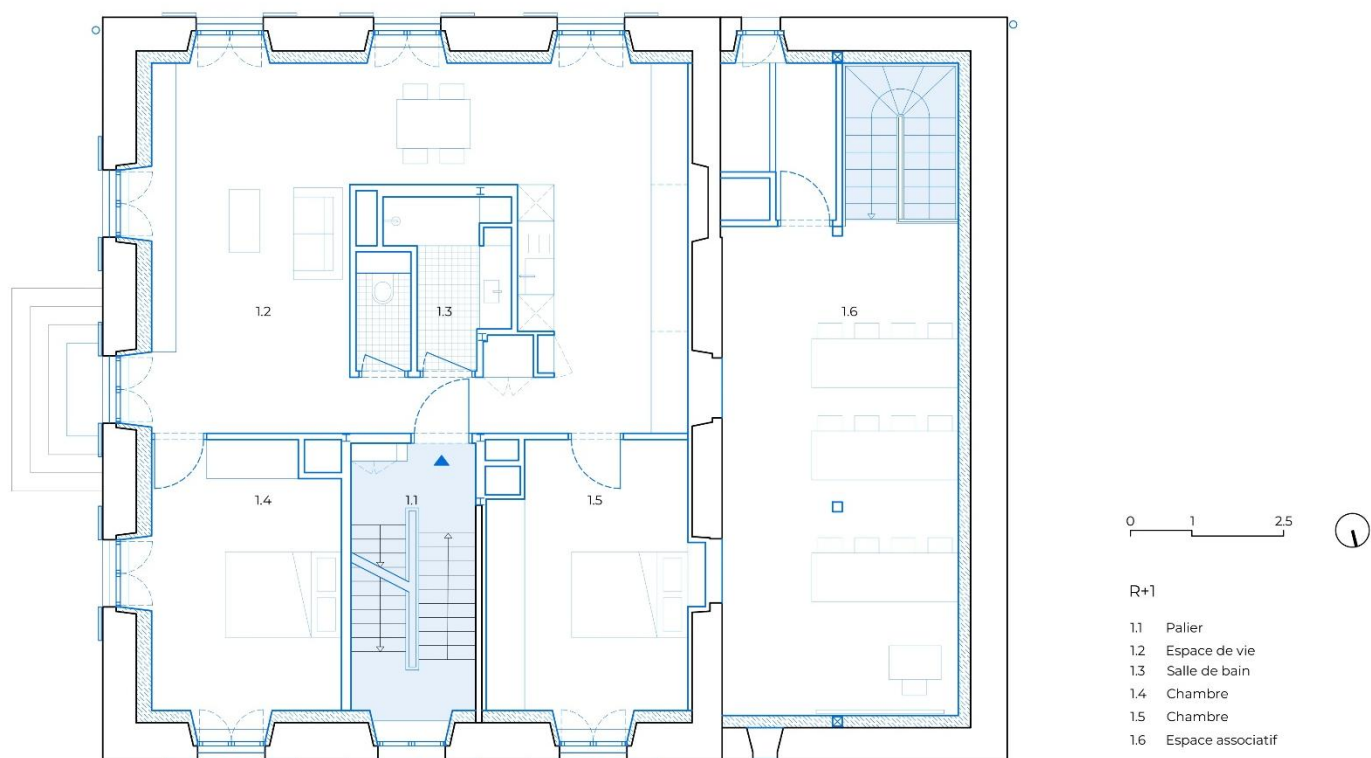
Plan projet R+1 (source Mayker Architectes)
